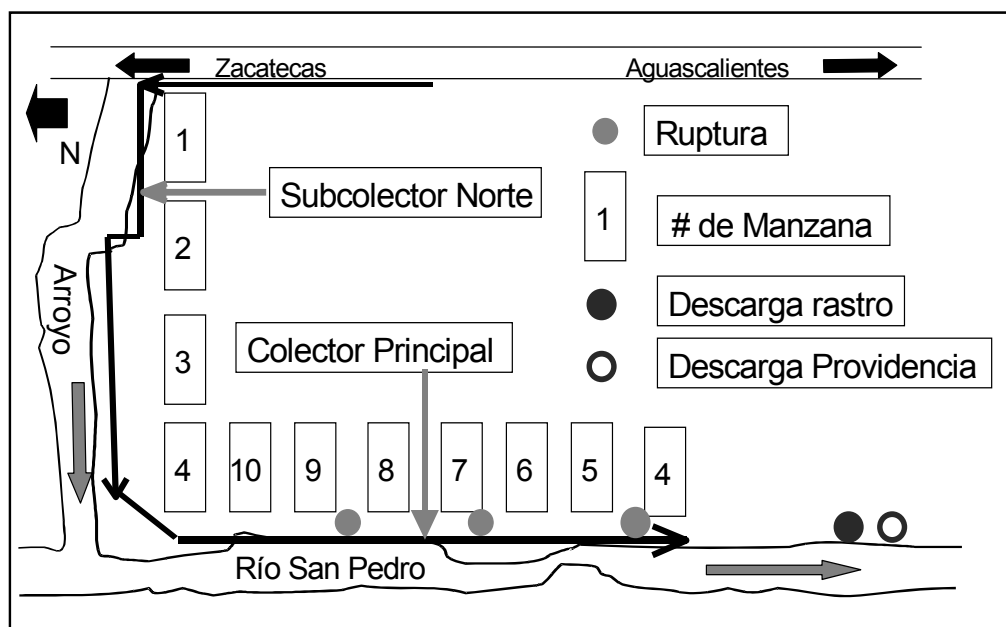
Croquis del sistema de alcantarillado de S. Francisco de los Romo, Ags. y de las descargas del rastro y La Providencia
